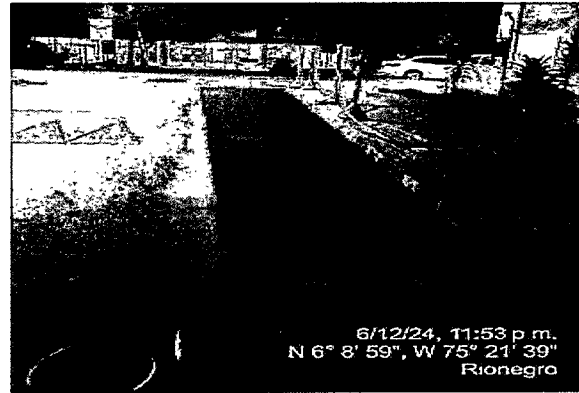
Levantamiento del pavimento existente fisurado barrio obrero sector cuatro esquinas
